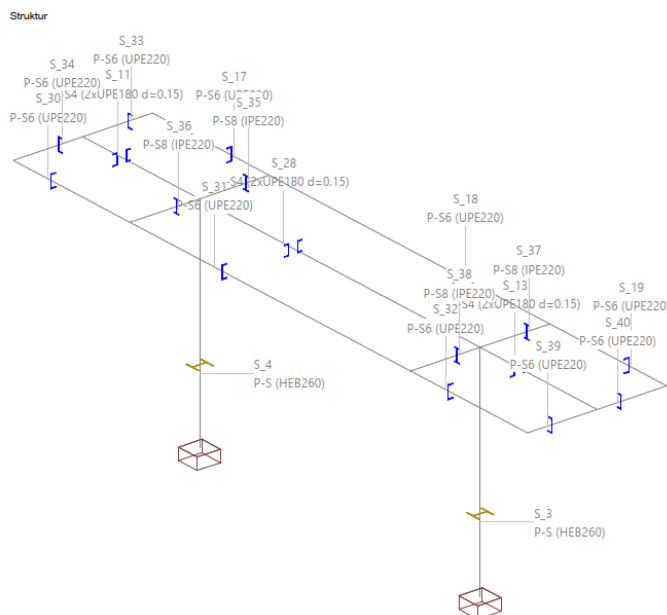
Struktur Haltestelle Bergfrieden / Schöneggstrasse - Ausschnitt aus dem Statik Modell
